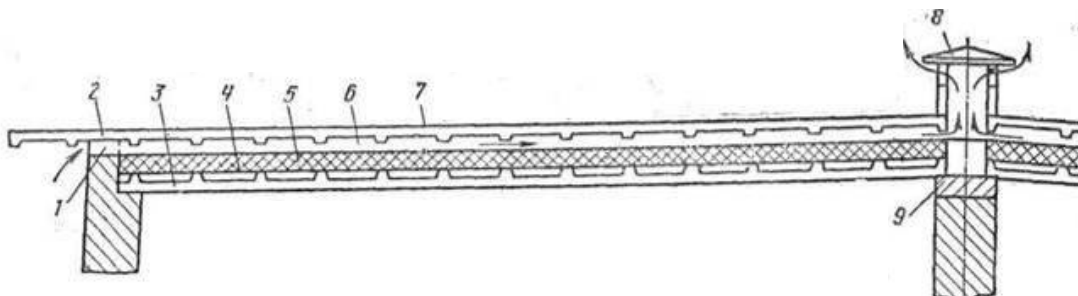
Совмещенная вентилируемая кровля из прокатных панелей:
